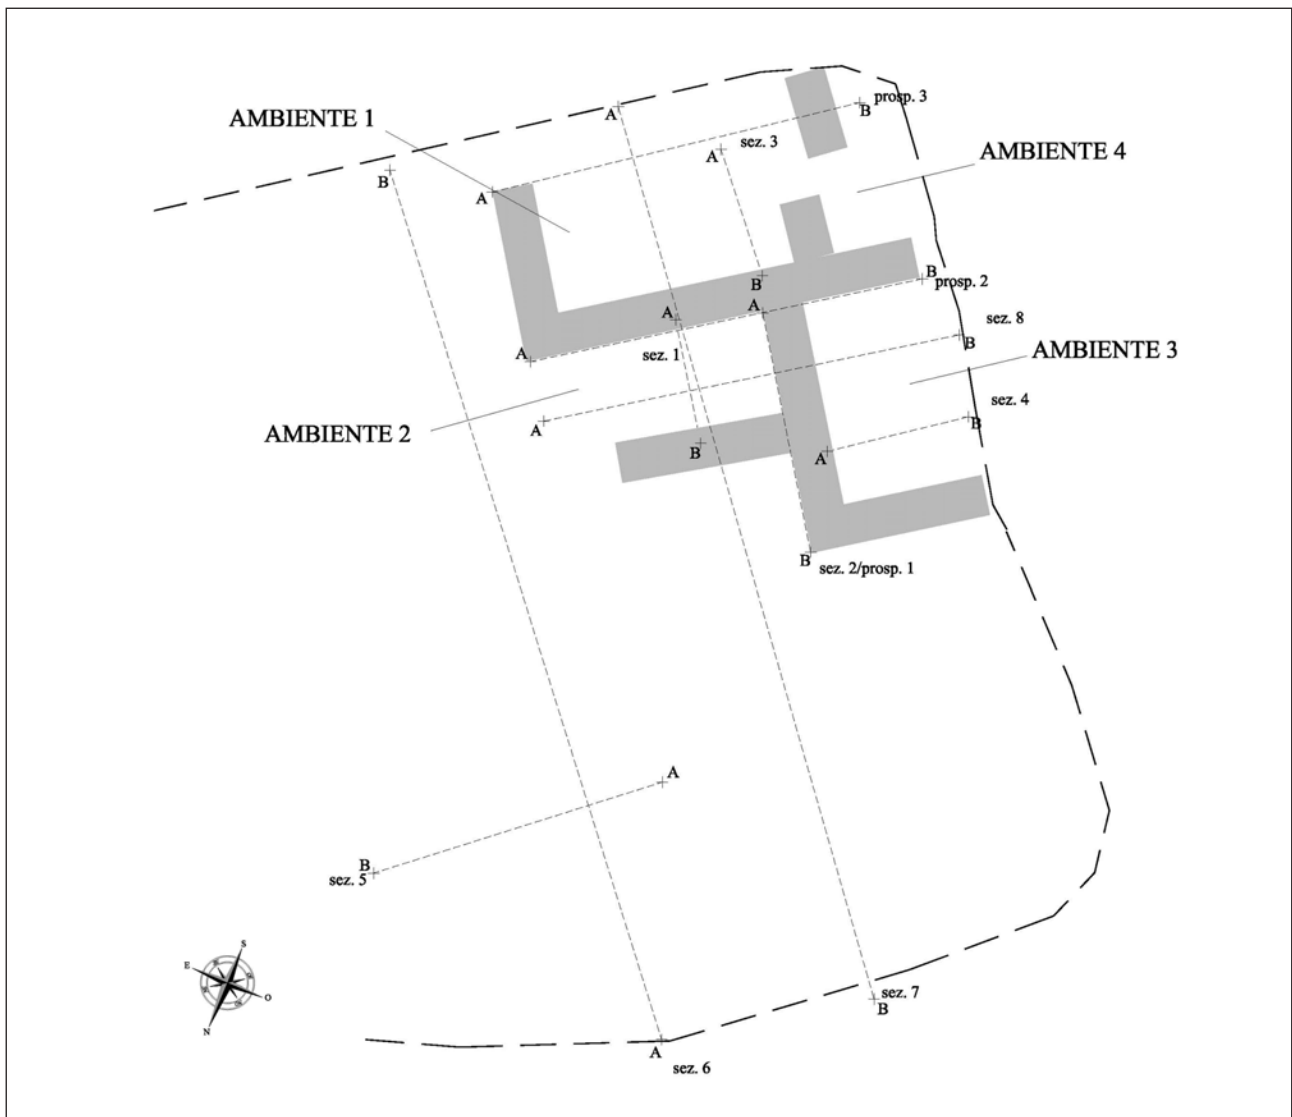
Cava di Ca' Castellina. Posizionamento delle sezioni.
